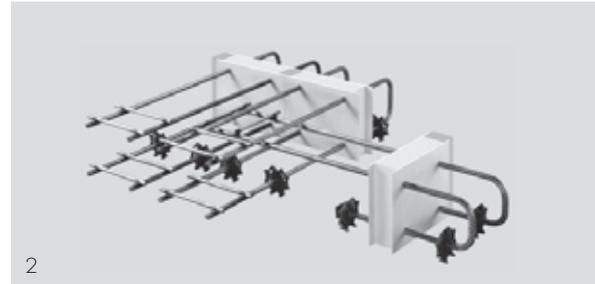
+2: Das ARBO-500E (Eckelement) weist bei der Zugbewehrung eine Betonüberdeckung von 40 mm sowie eine verkürzte Druckbewehrung auf. Damit ist eine rechtwinklig direkt anschließende Anordnung zum ARBO-500 Element möglich, ohne Konflikte bei den Bewehrungslagen.
